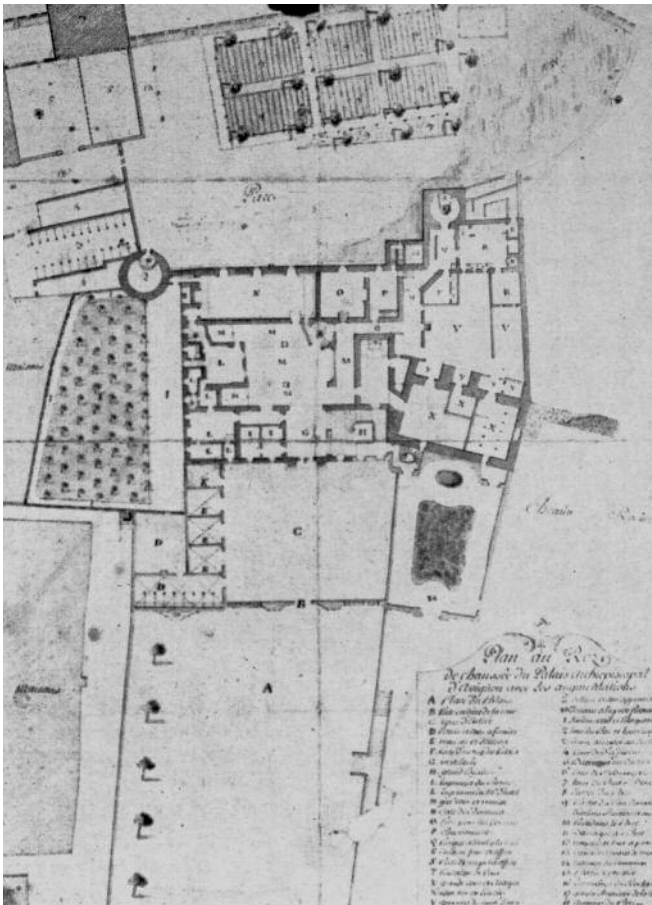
Avignone. Petit Palais, planimetria del piano terra del palazzo, s.d. [1764-76], s.a. Avignone, Musée Calvet.
